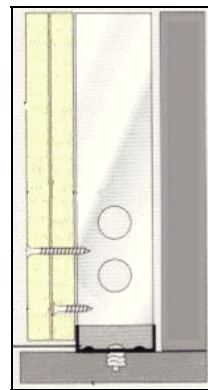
esempio di posa corretta del telaio metallico, fissato alla pavimentazione e desolidarizzato dalla parete
